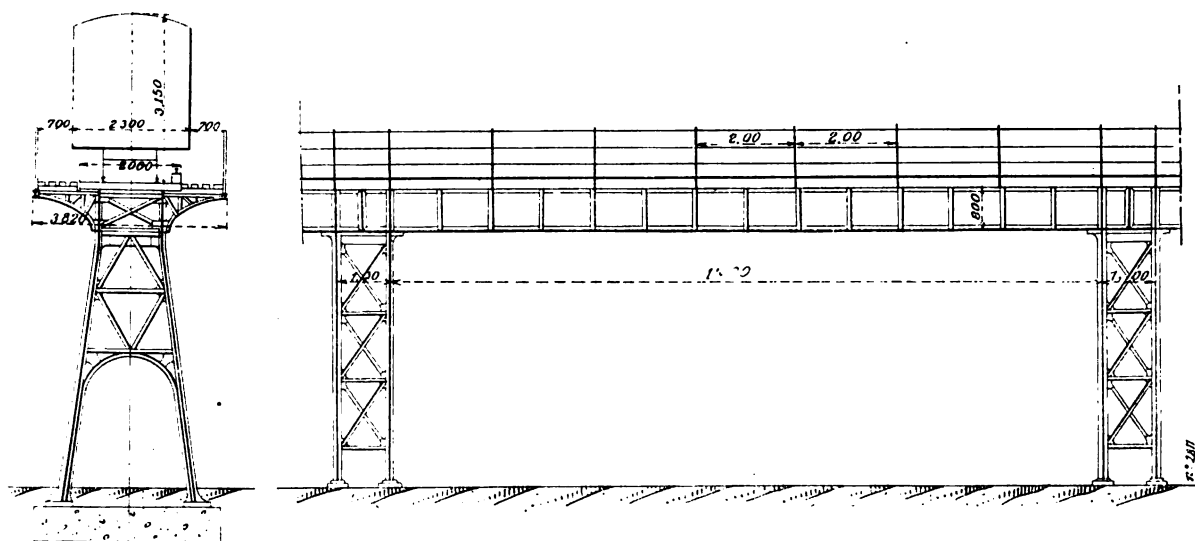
et 27. — Coupe transversale et élévation longitudinale du viaduc.
